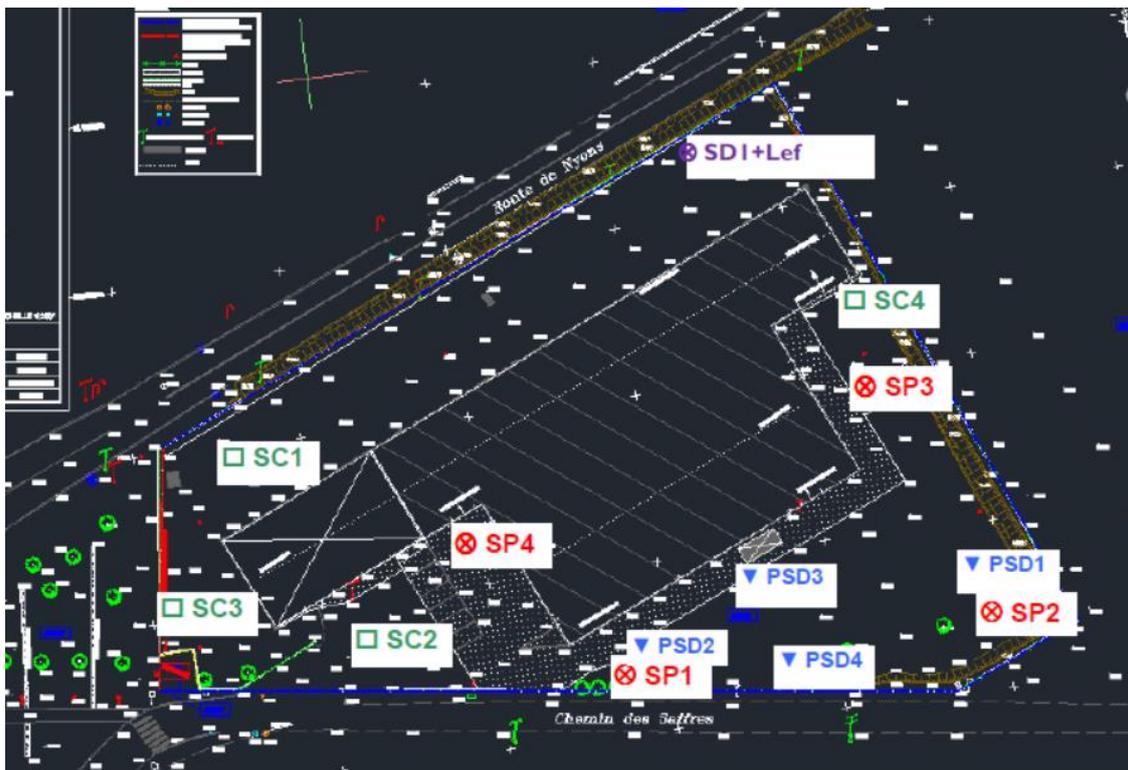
Plan d'implantation des sondages (source : Fondasol)
